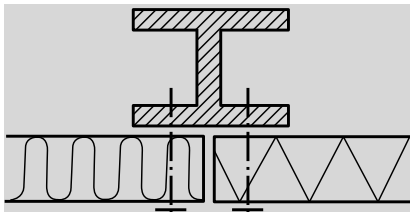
/2. INFÄSTNING TILL BETONGKONSTRUKTION.
